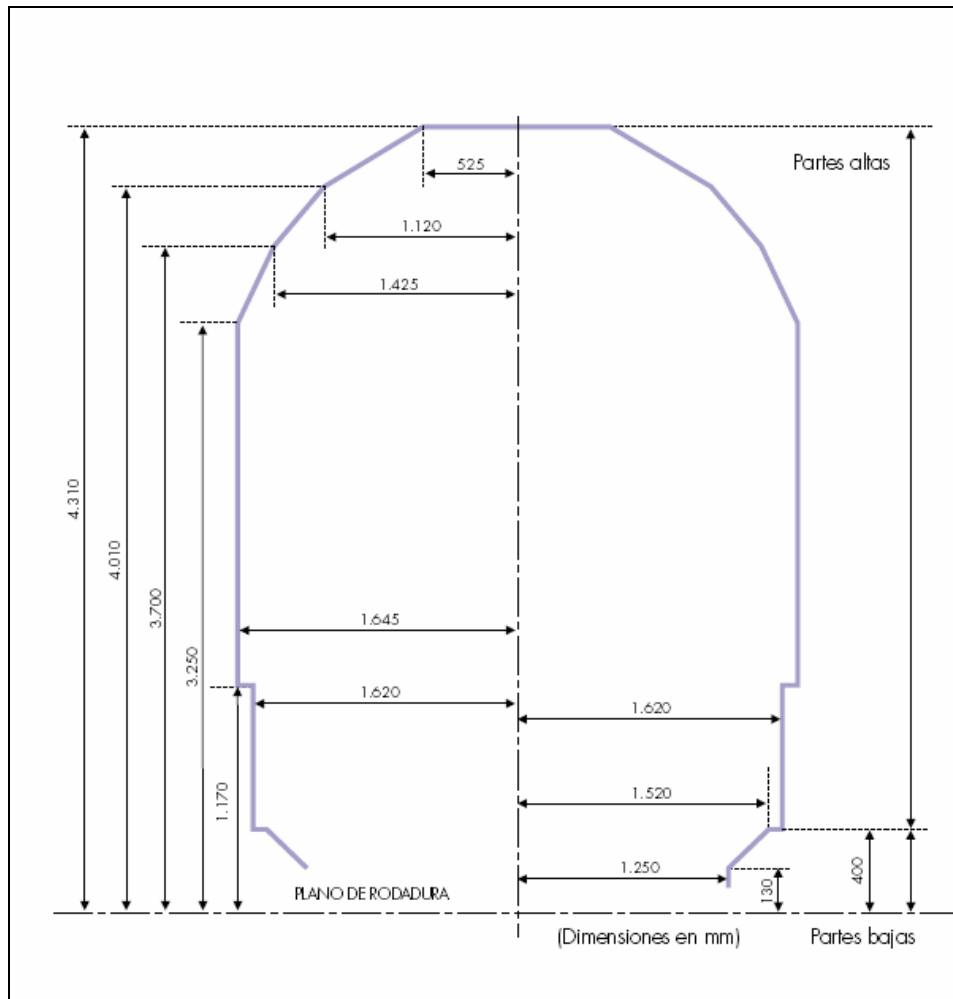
Gálibo ancho UIC (1435mm)
